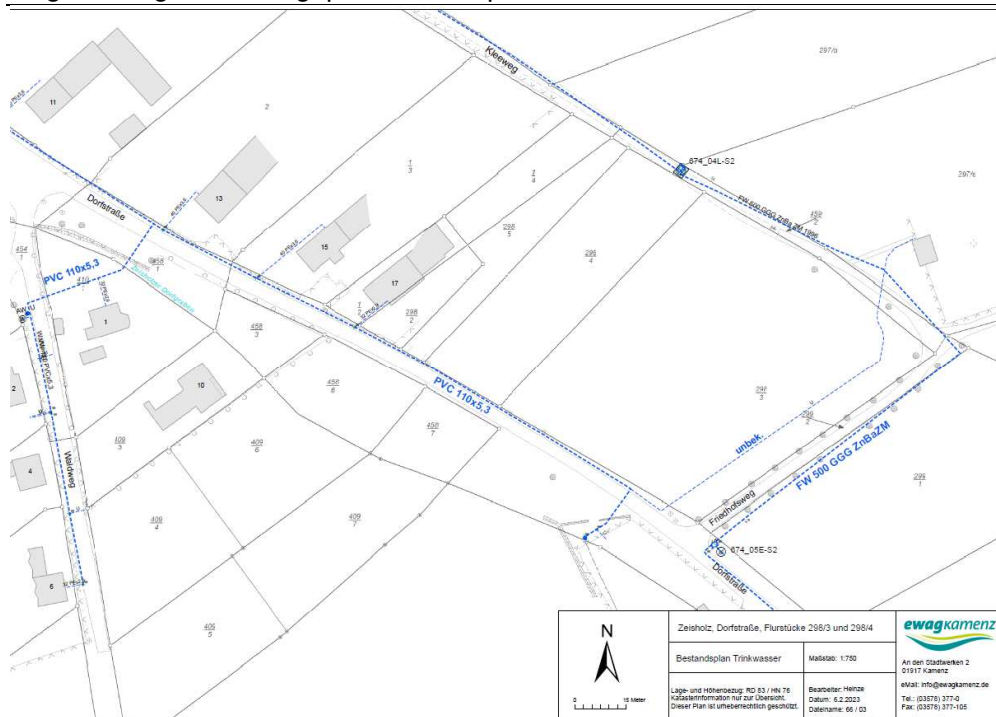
Bestandsplan Trinkwasser ewag Kamenz
